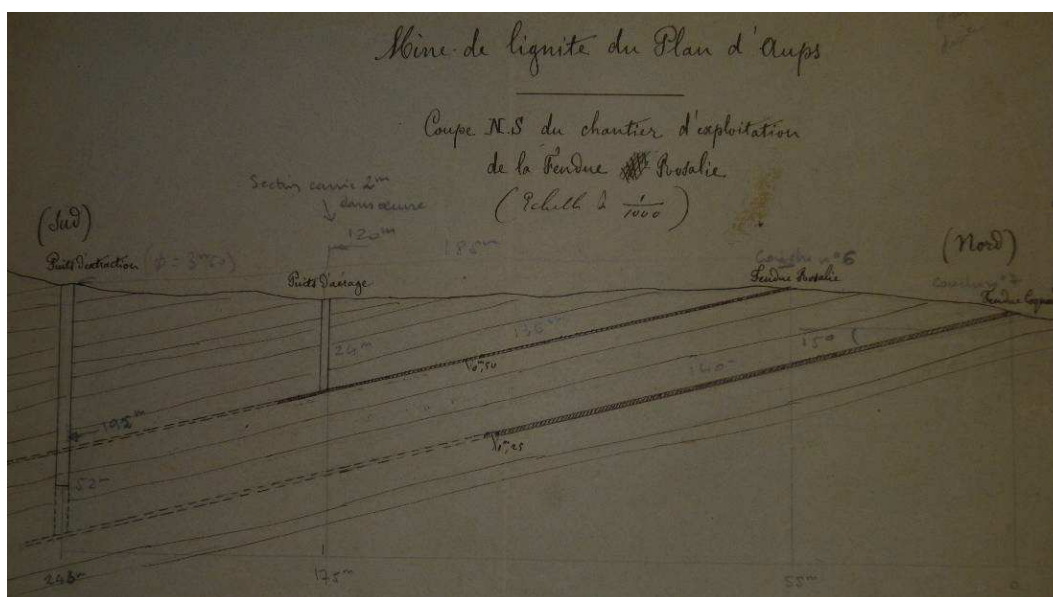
Coupe des travaux du secteur Giniez (cf. [13]).
